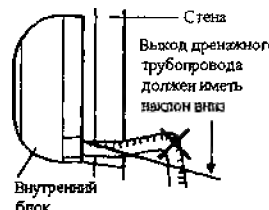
Особенности монтажа дренажного трубопровода
